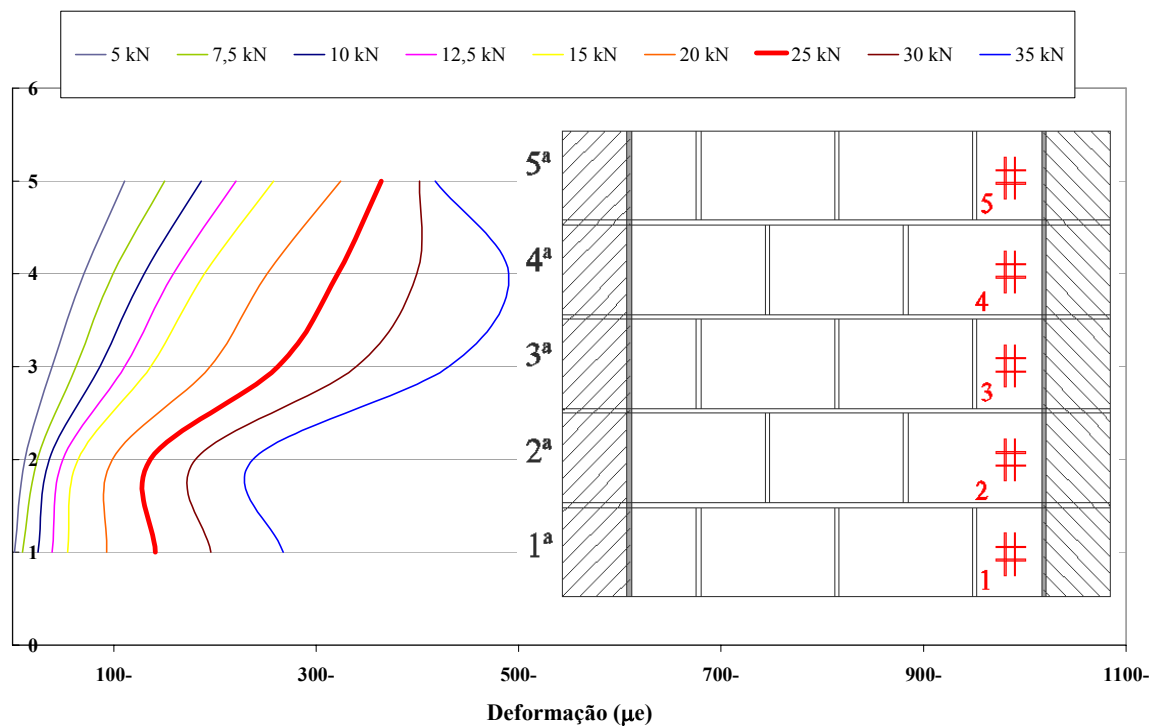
Deformação dos extensômetros na Parede Central (PH2_03)
